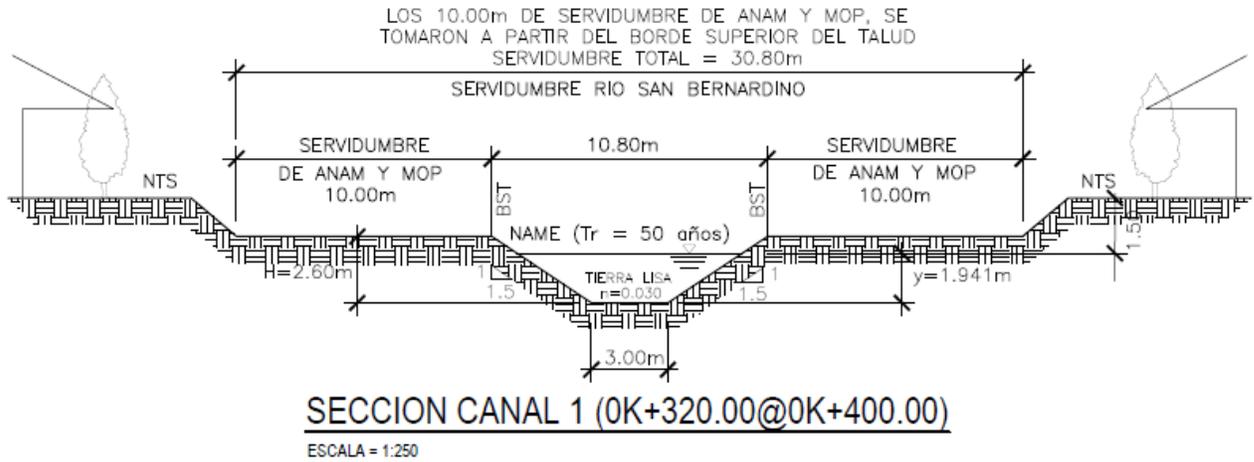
Sección de Canal. Fuente: Corporación de Ingeniería Fénix S.A.
